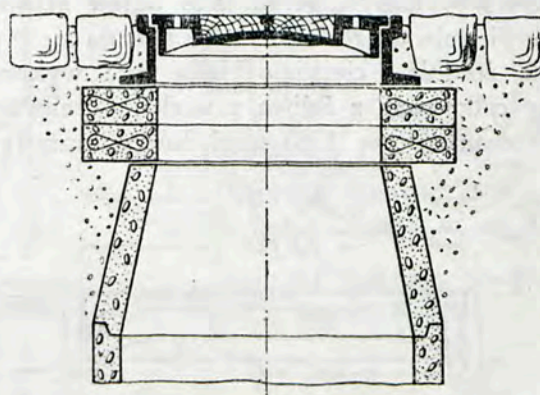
Pokrywa z wiekiem wypełnionym asfaltem.
